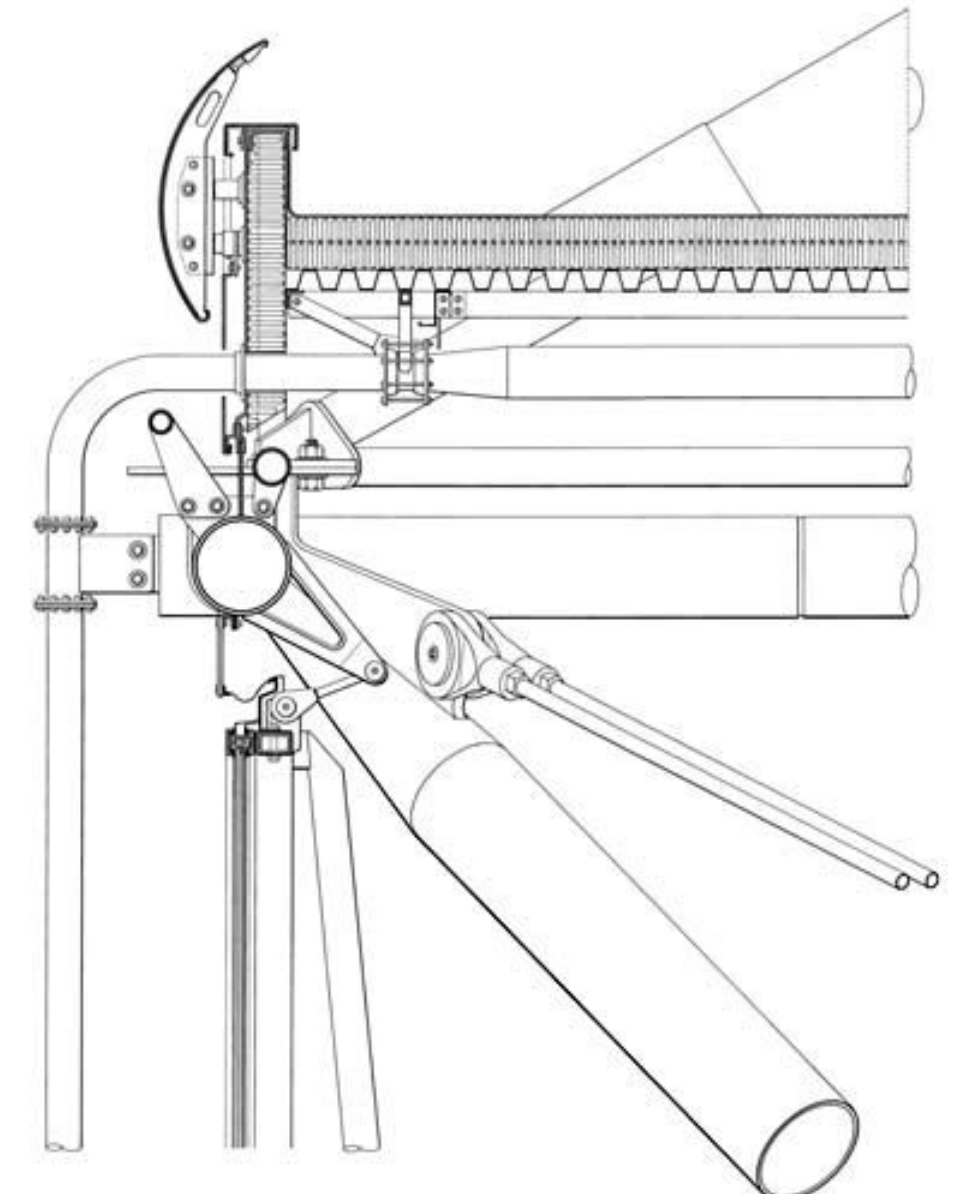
Detalle constructivo del encuentro del muro cortina con la cubierta
